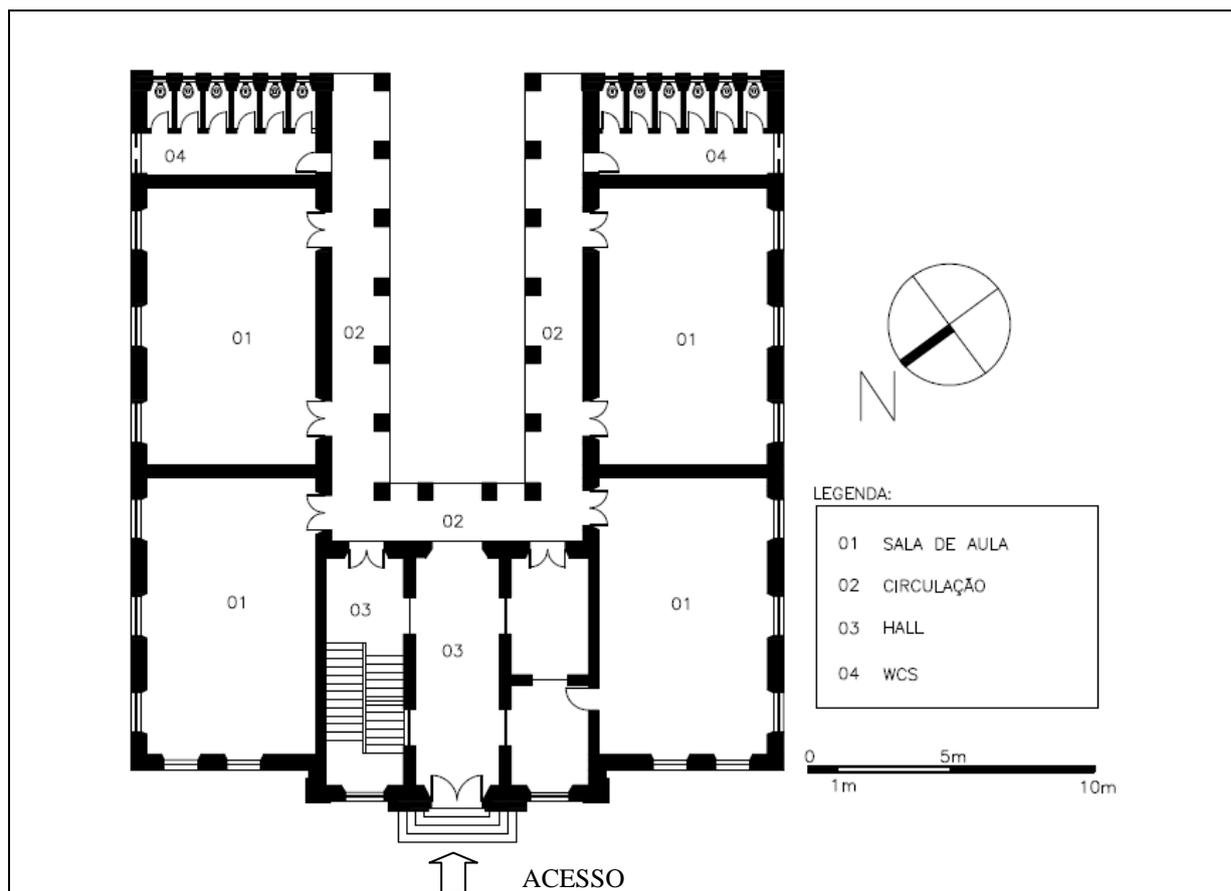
Planta pavimento Térreo Grupo Escolar Rodolfo Teófilo
